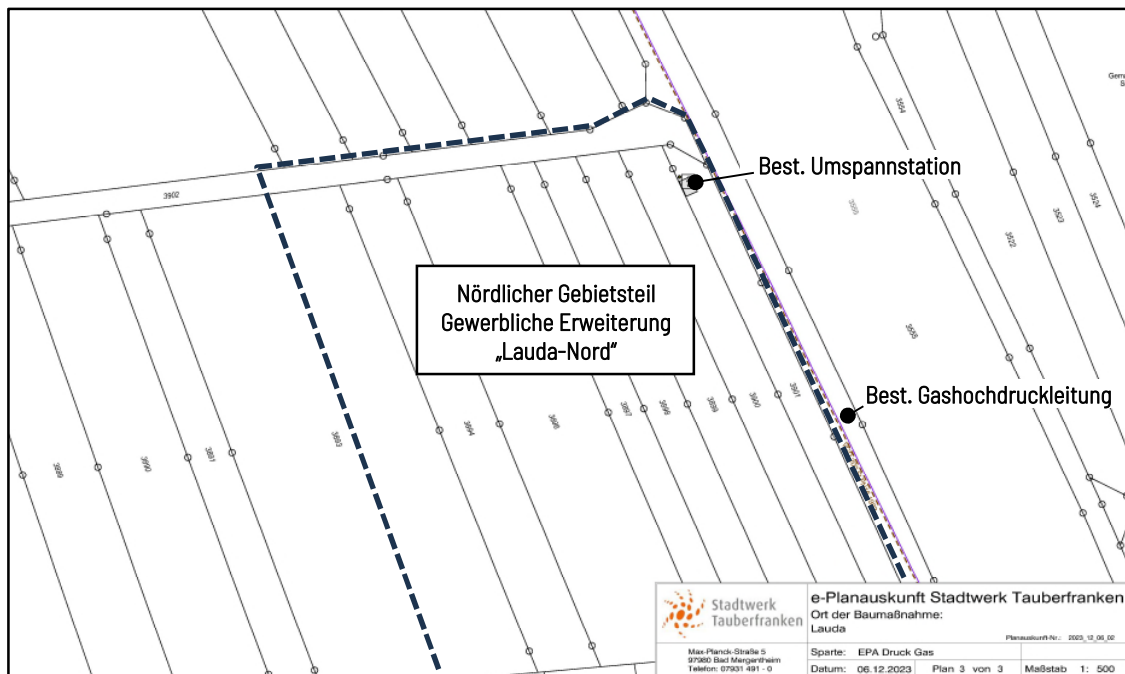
Bestandsplan Trasse Gashochdruckleitung – Quelle: Stadtwerk Tauberfranken
